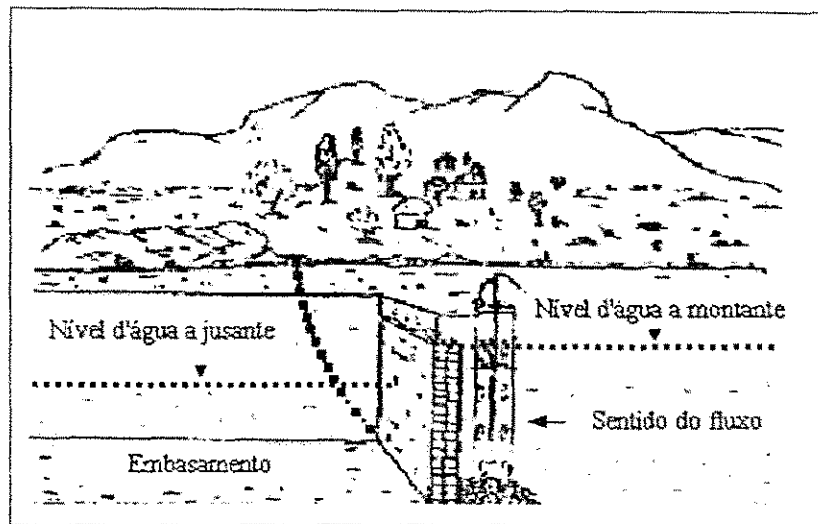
Esboço das características gerais de uma barragem subterrânea com poço a montante (fonte: adaptado de HANSON & NILSSON (1986),
